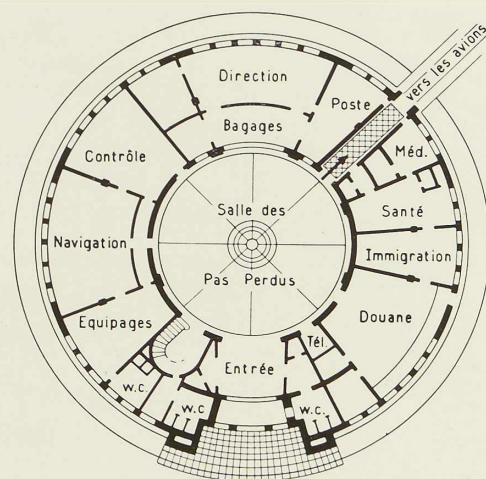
Plan du rez-de-chaussée du bâtiment administratif de la base d'hydravions.
